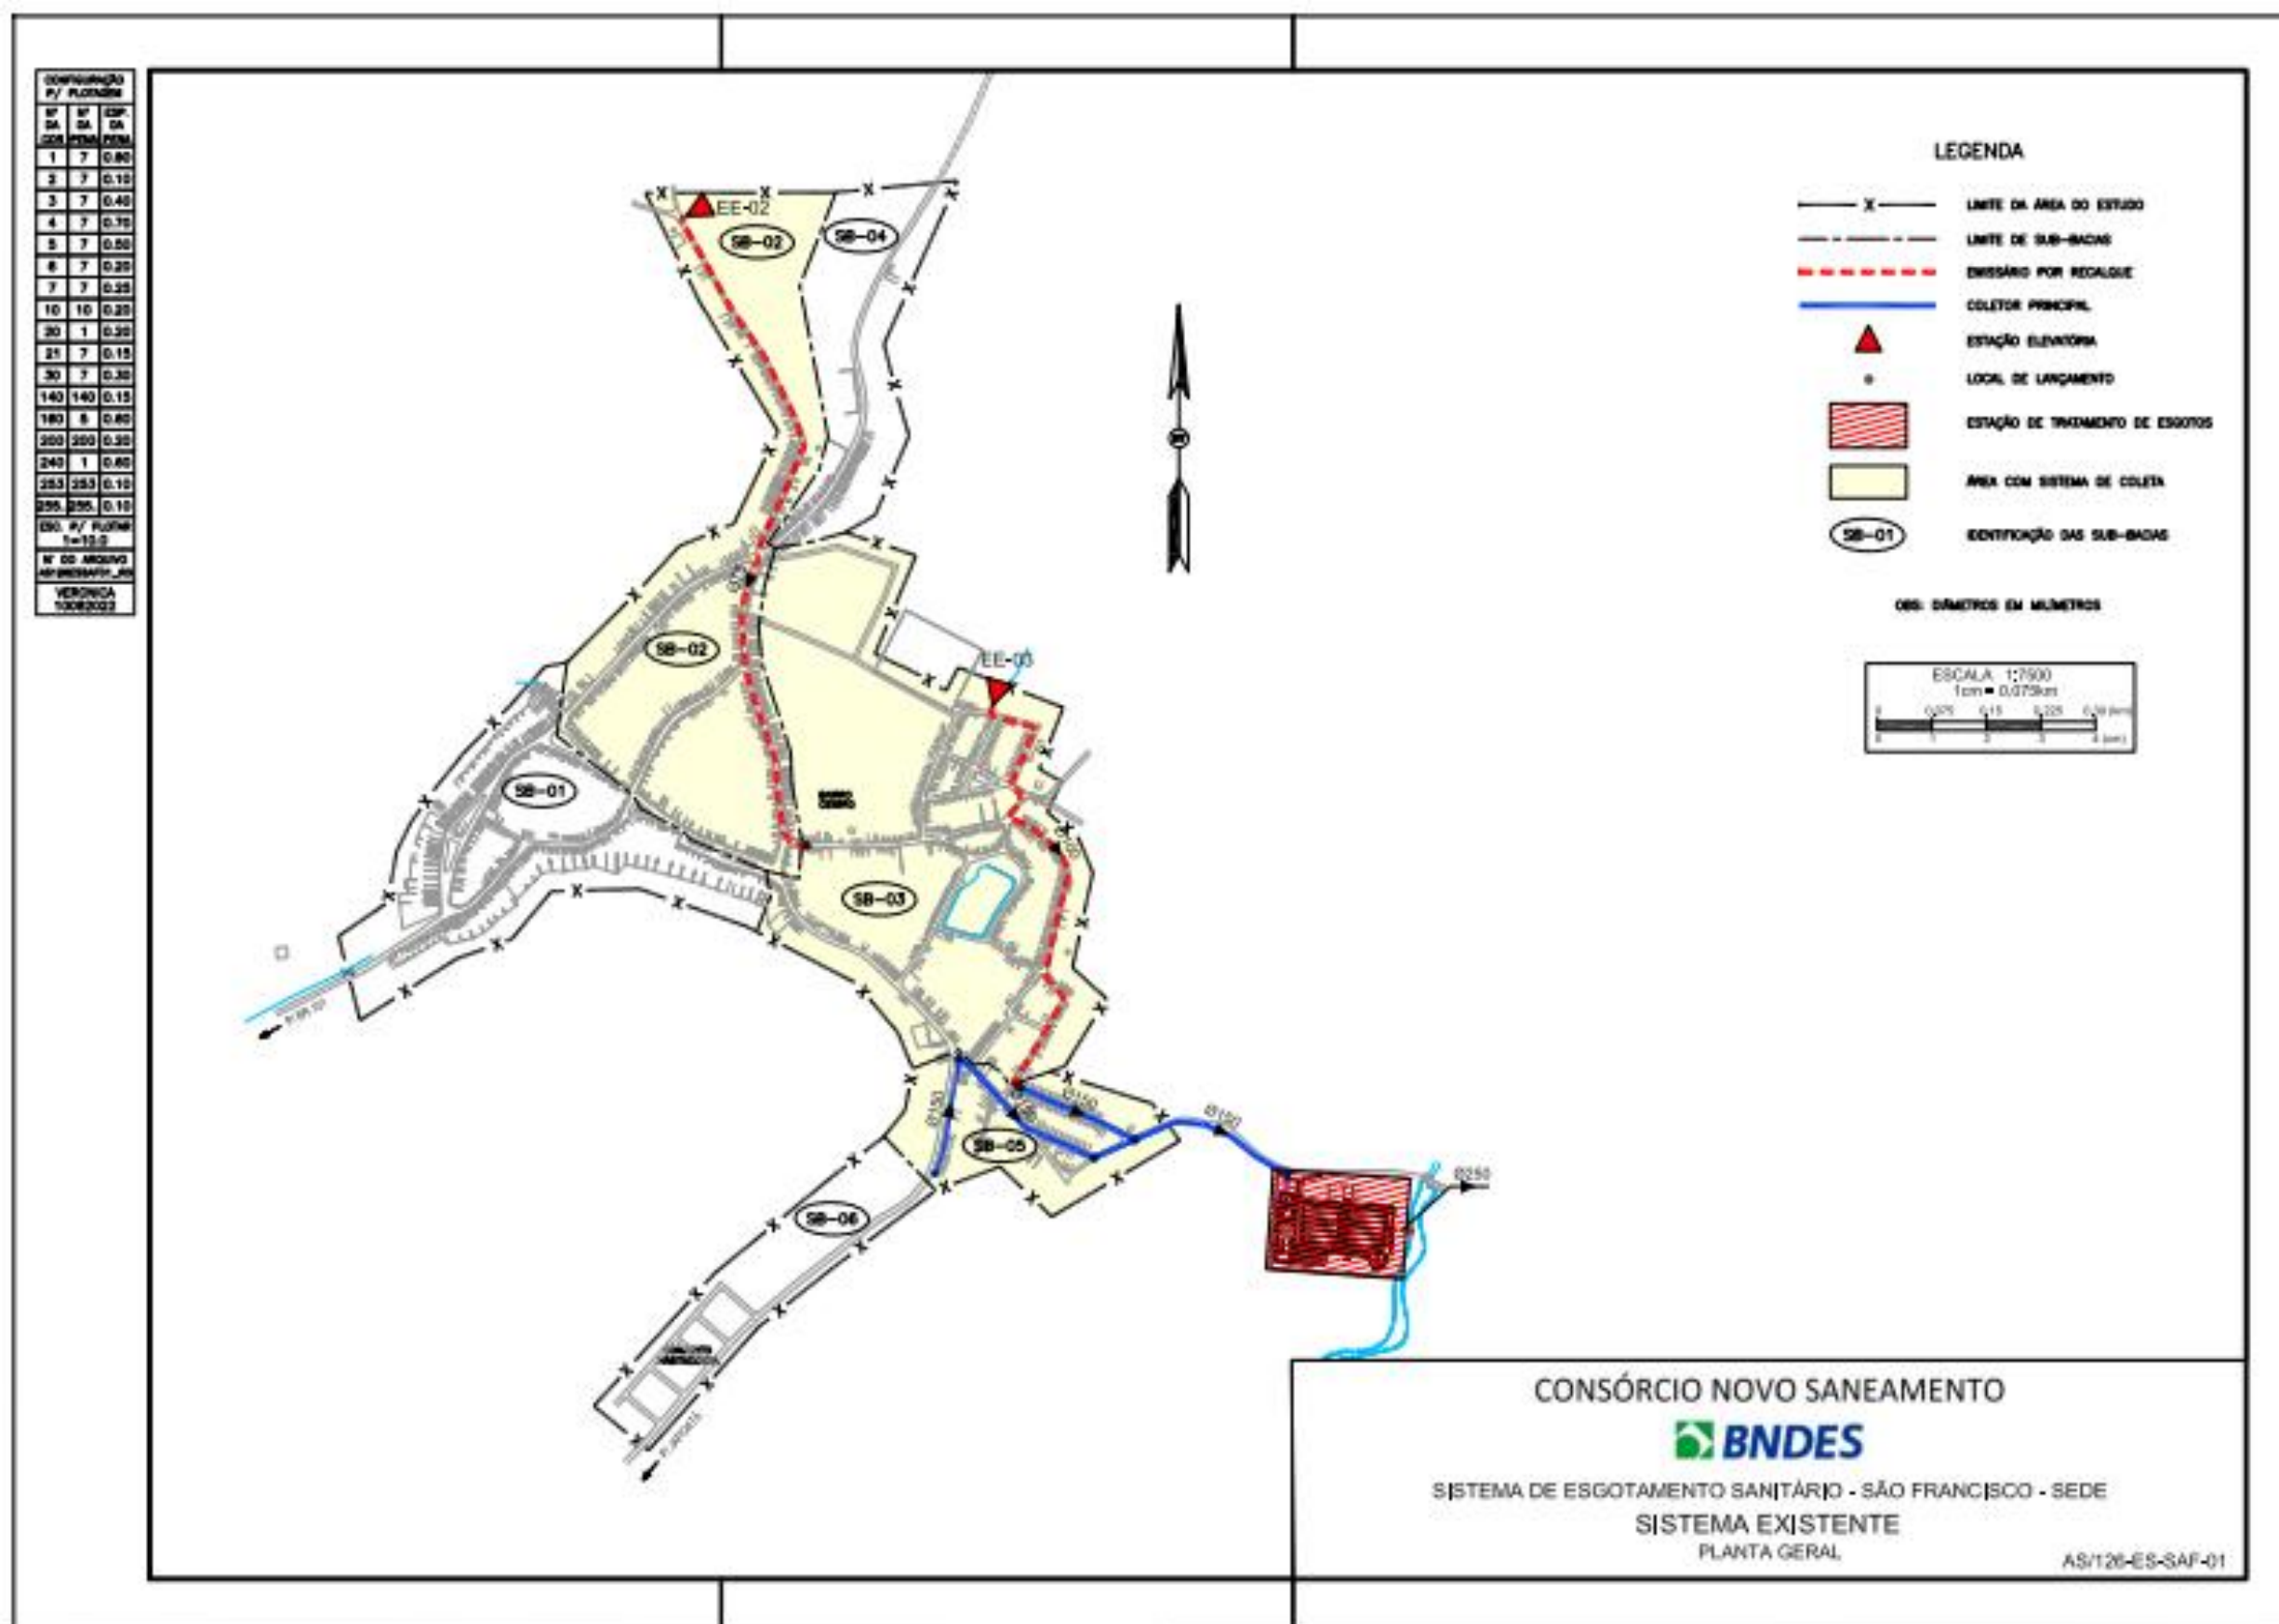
Planta do Sistema de Esgotamento Sanitário – SÃO FRANCISCO
